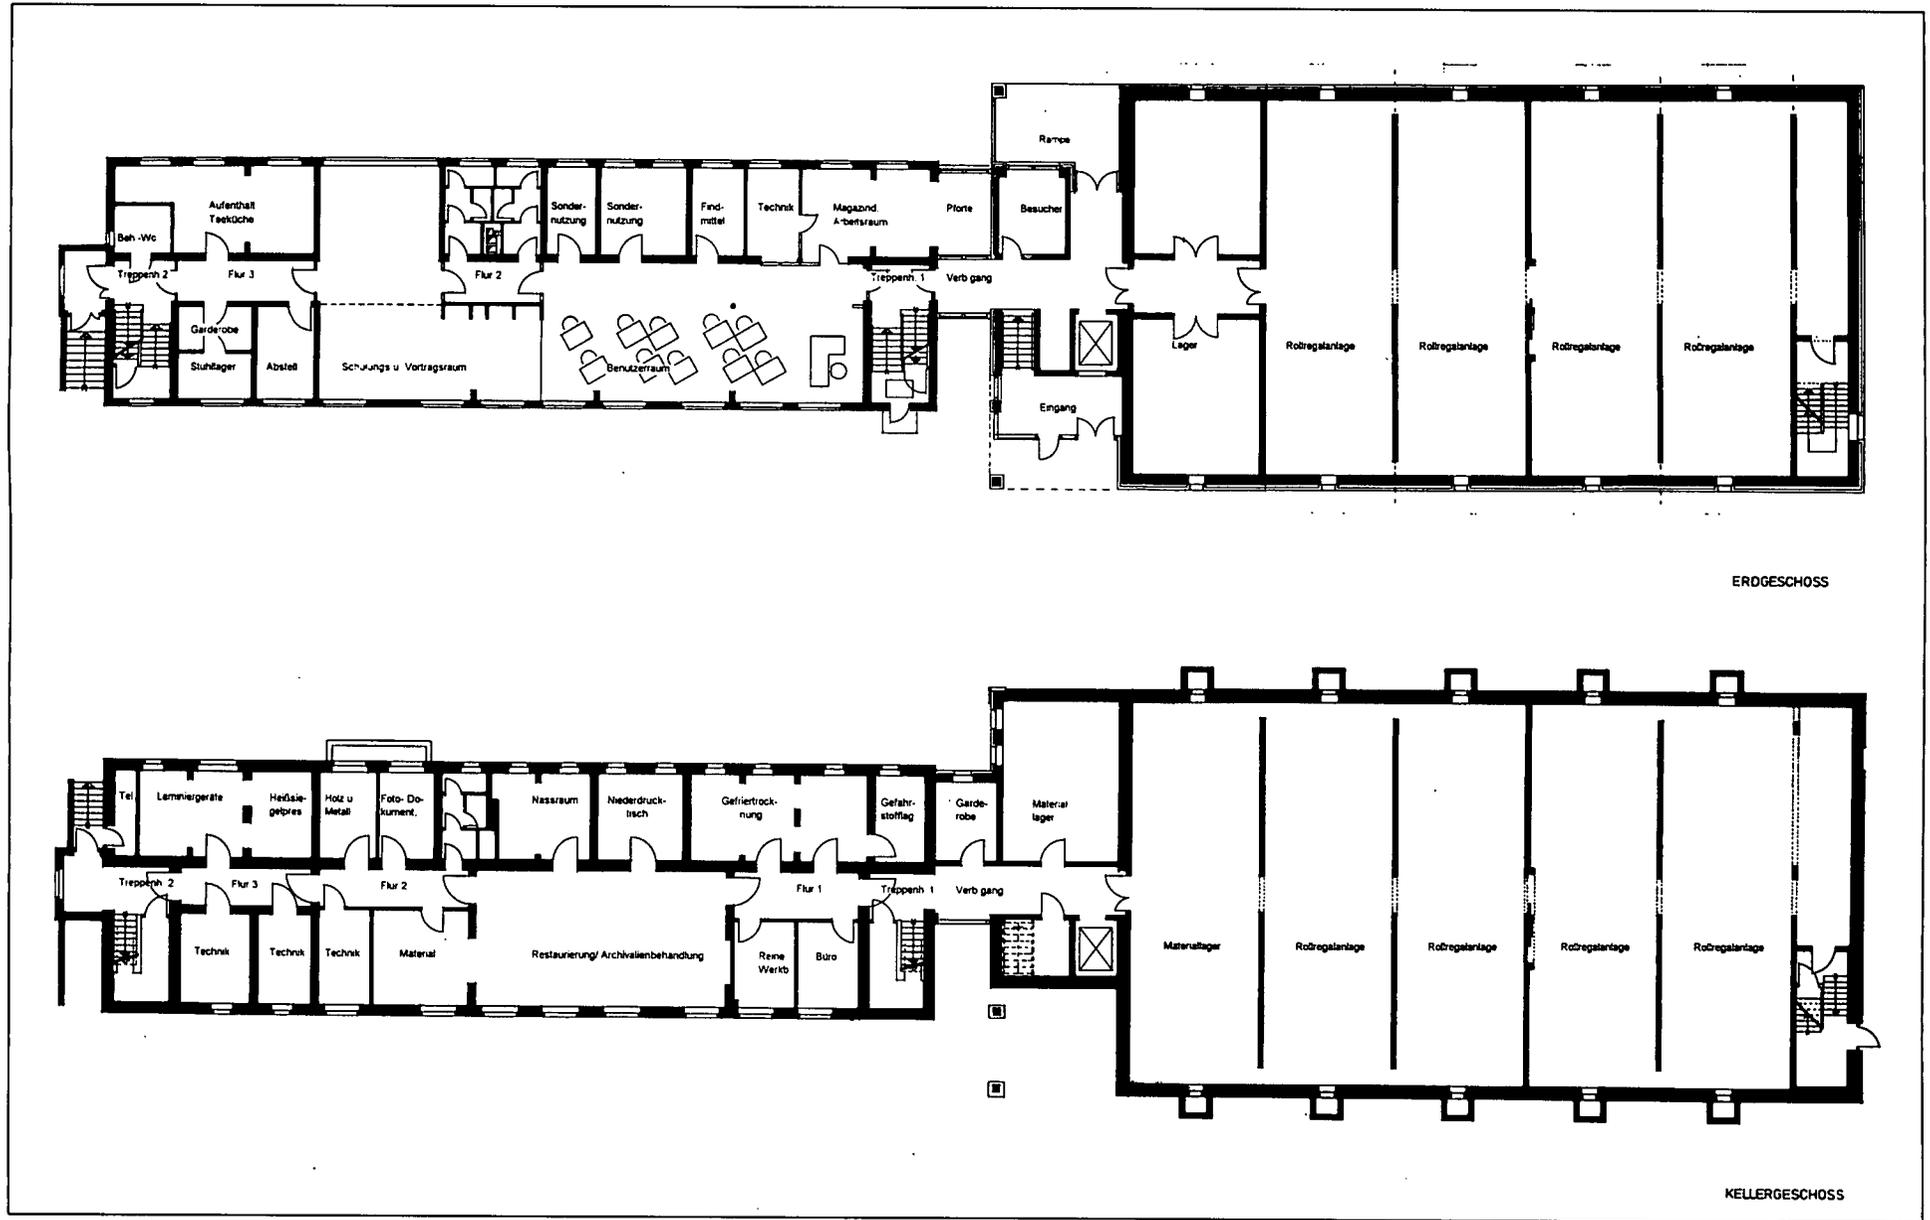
, 9: Neubau Westfälisches Archivamt - Grundrisse Erdgeschoss und Souterrain
